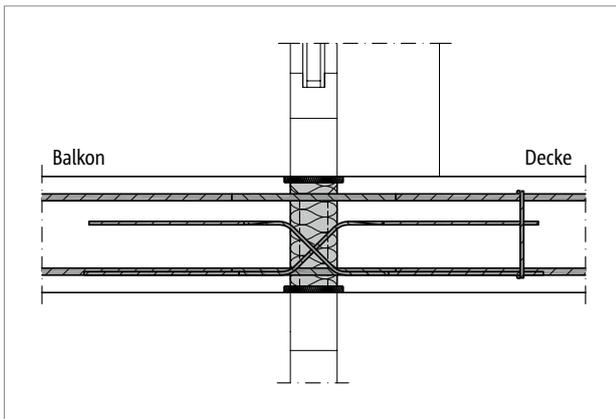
Schöck Isokorb® T Typ DP: Einbauschnitt; einachsig gespannte Decke
